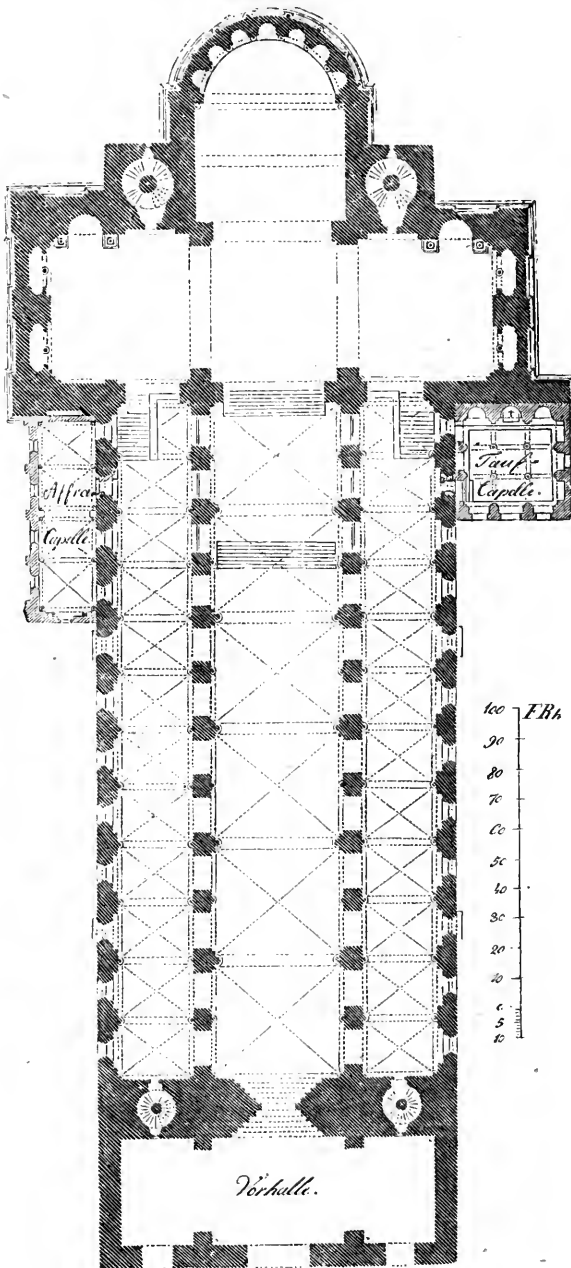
Dom zu Speyer, Grundriss.
